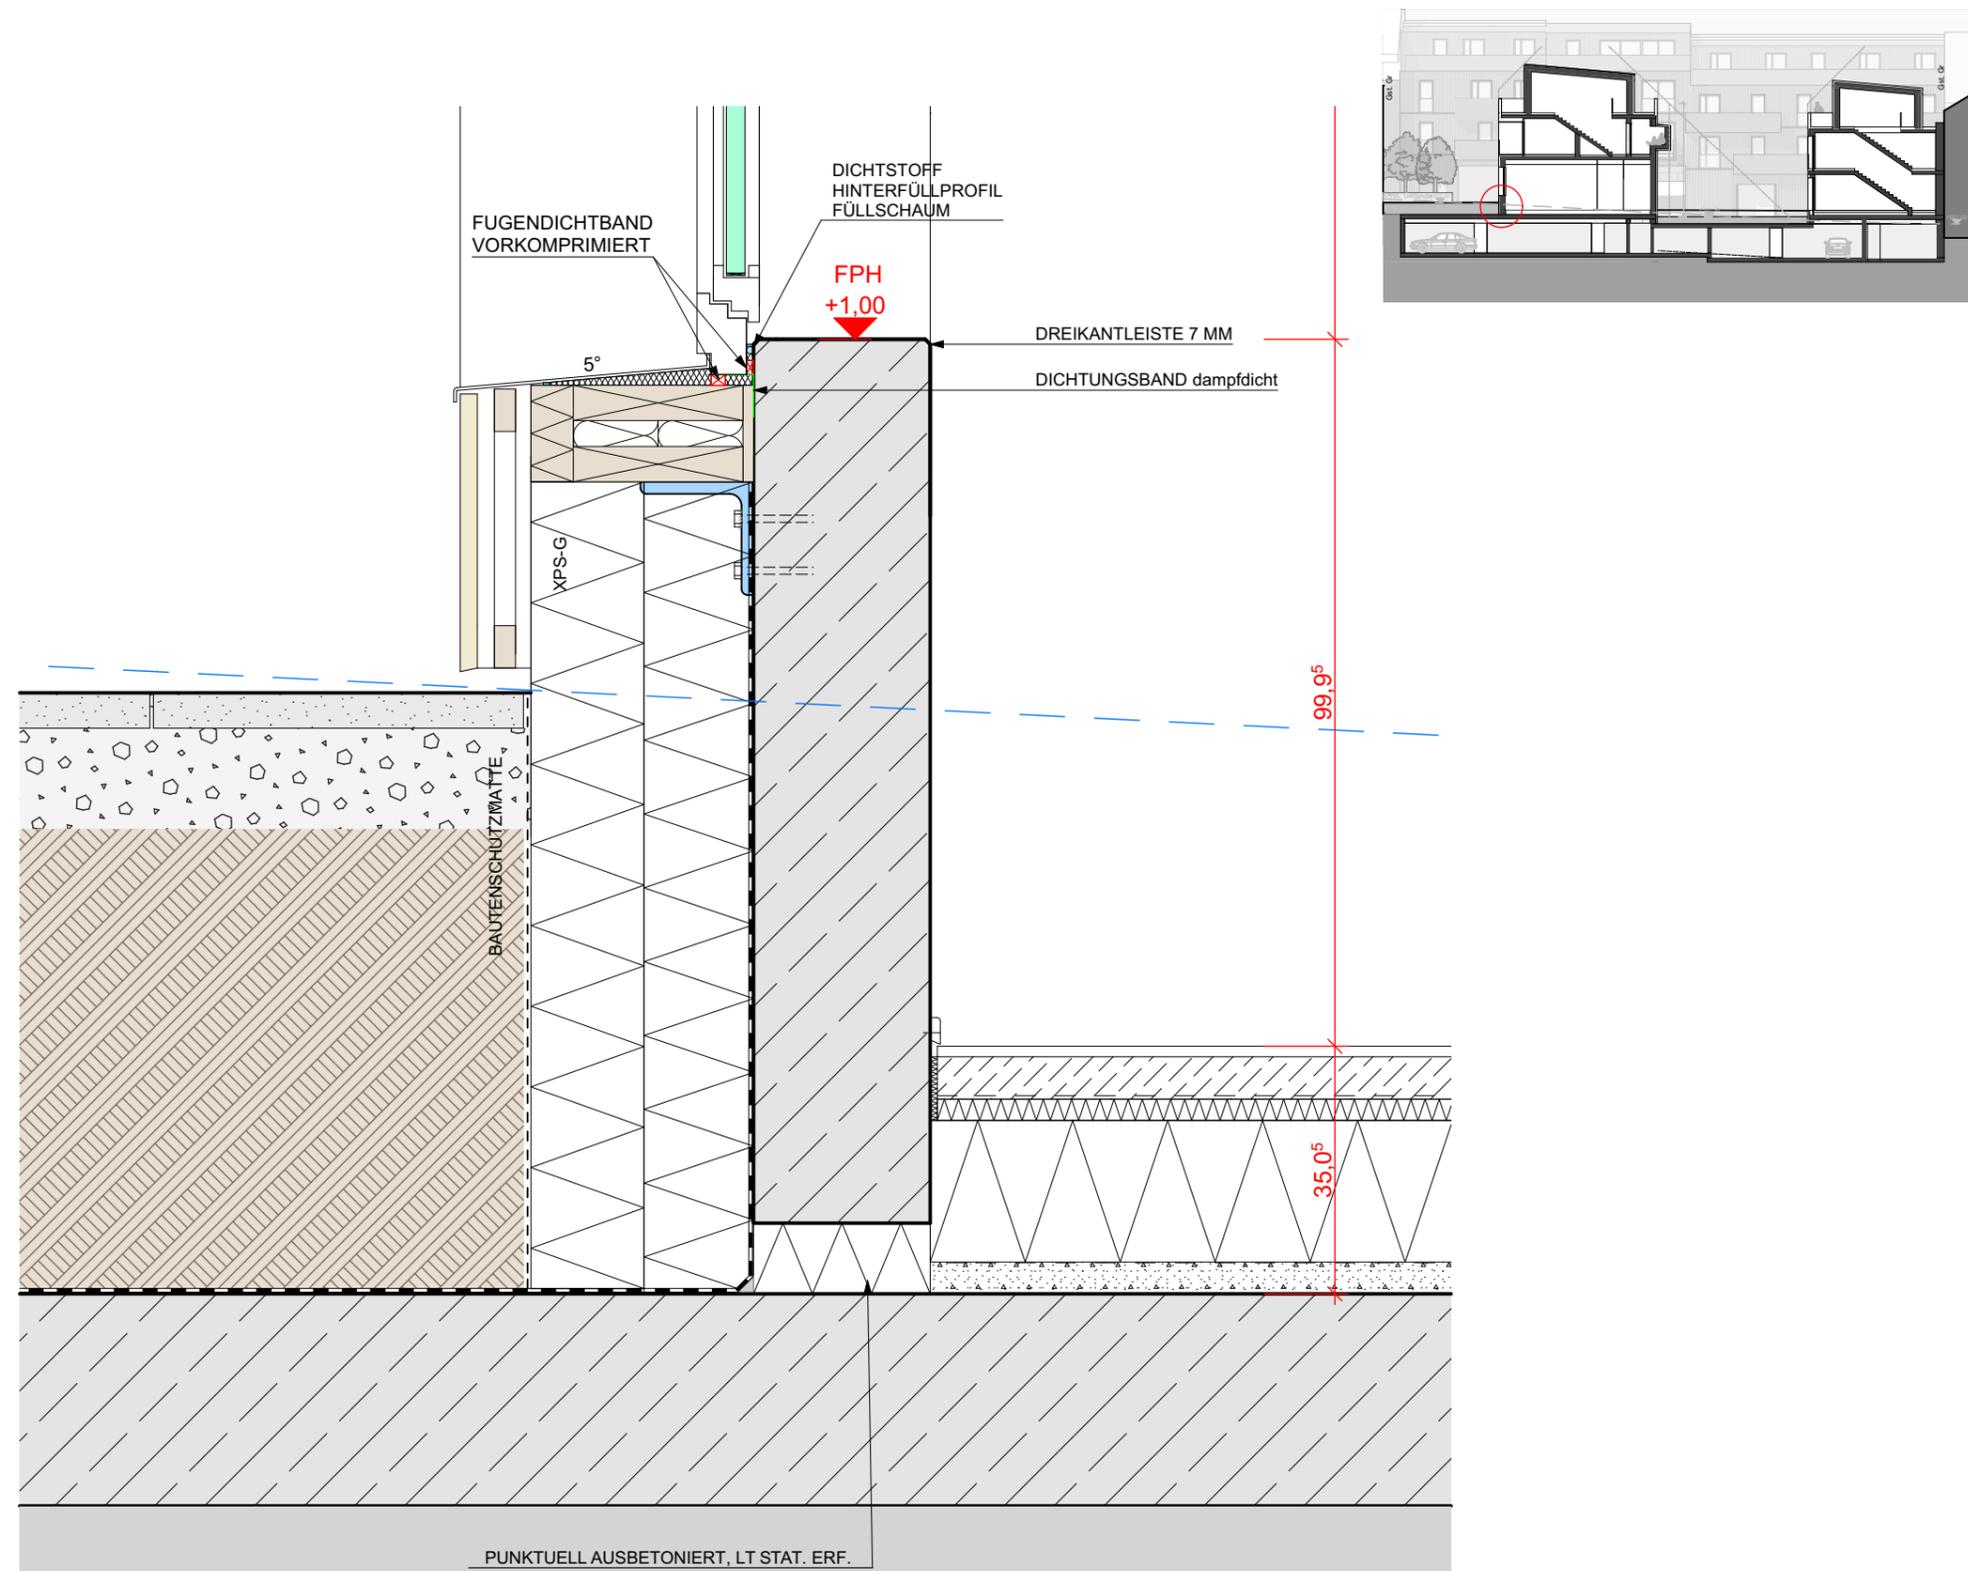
Bauteil 2: Sockelanschluss 1:10
